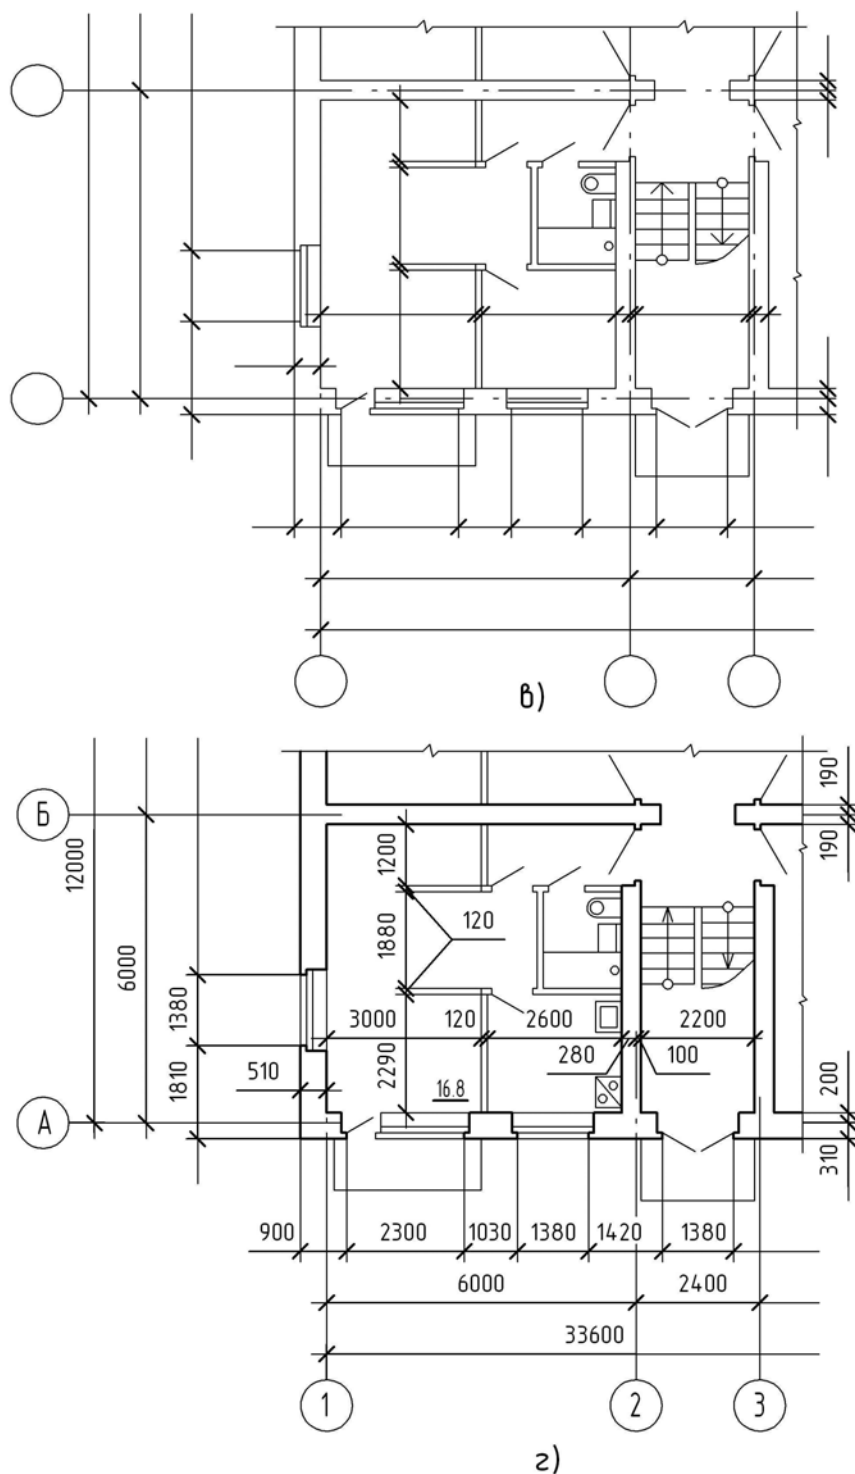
(в, г). Последовательность вычерчивания плана здания
